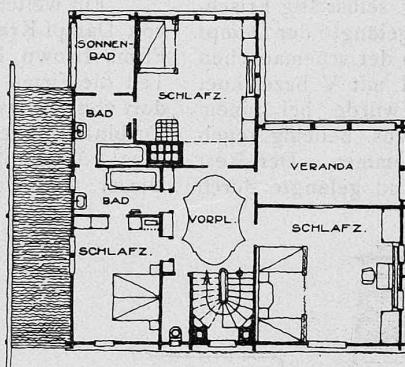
und 6. Grundriss vom Erdgeschoss und Obergeschoss des Hauses Stoffel. — 1:400.
